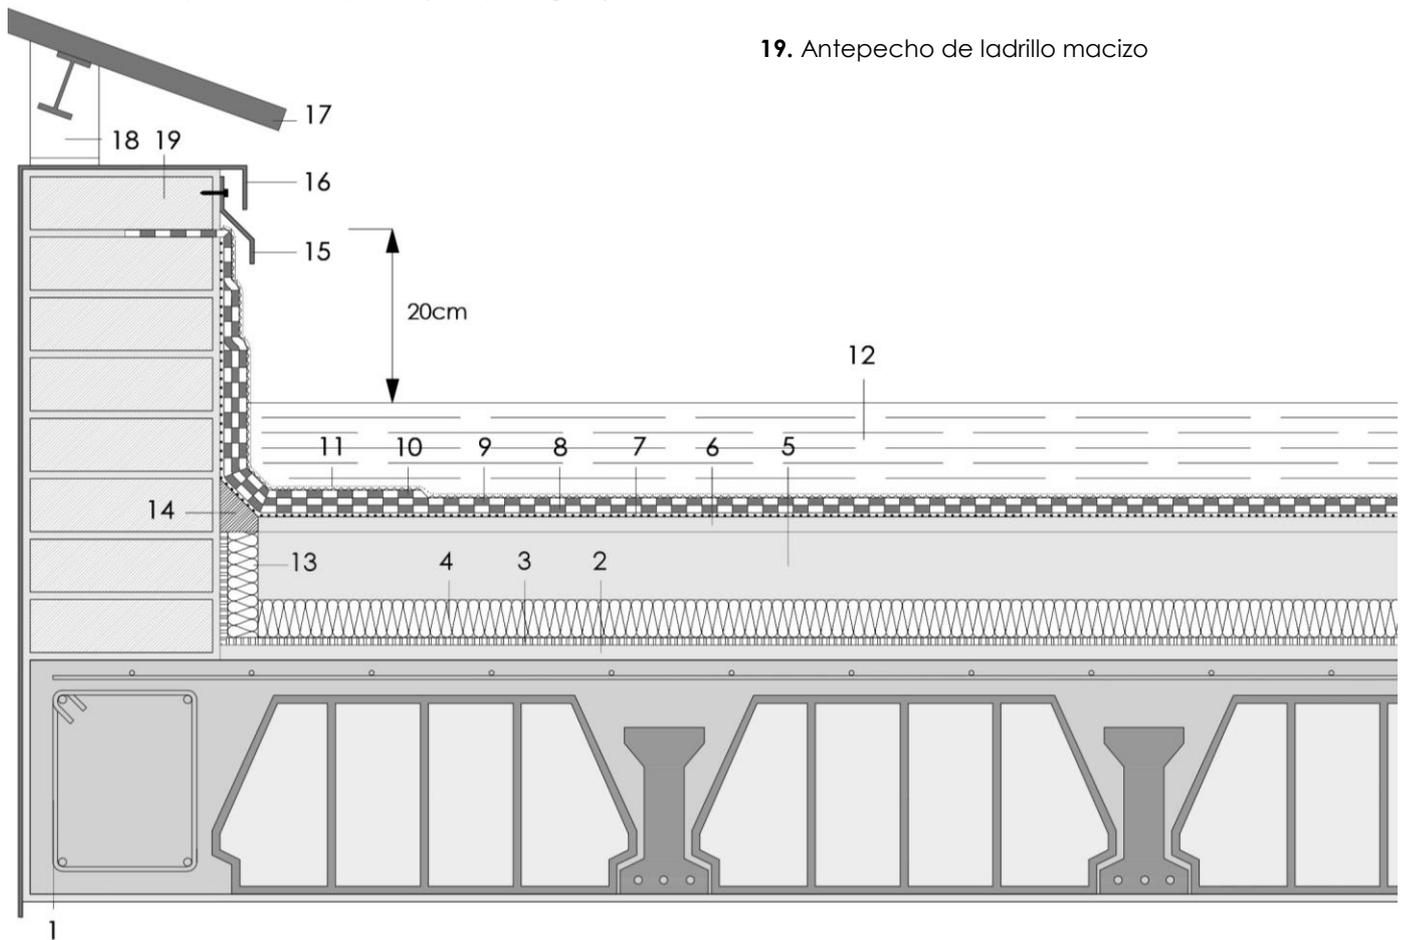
Sección constructiva del peto perimetral interior. E: 1/10
